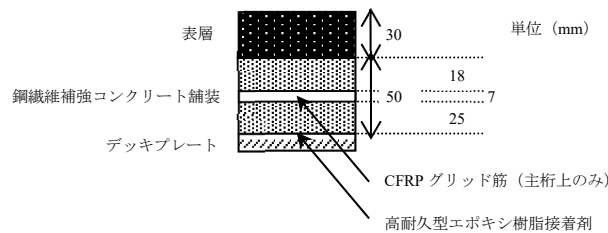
鋼床版の鋼繊維補強コンクリート舗装断面例⁹³⁾
